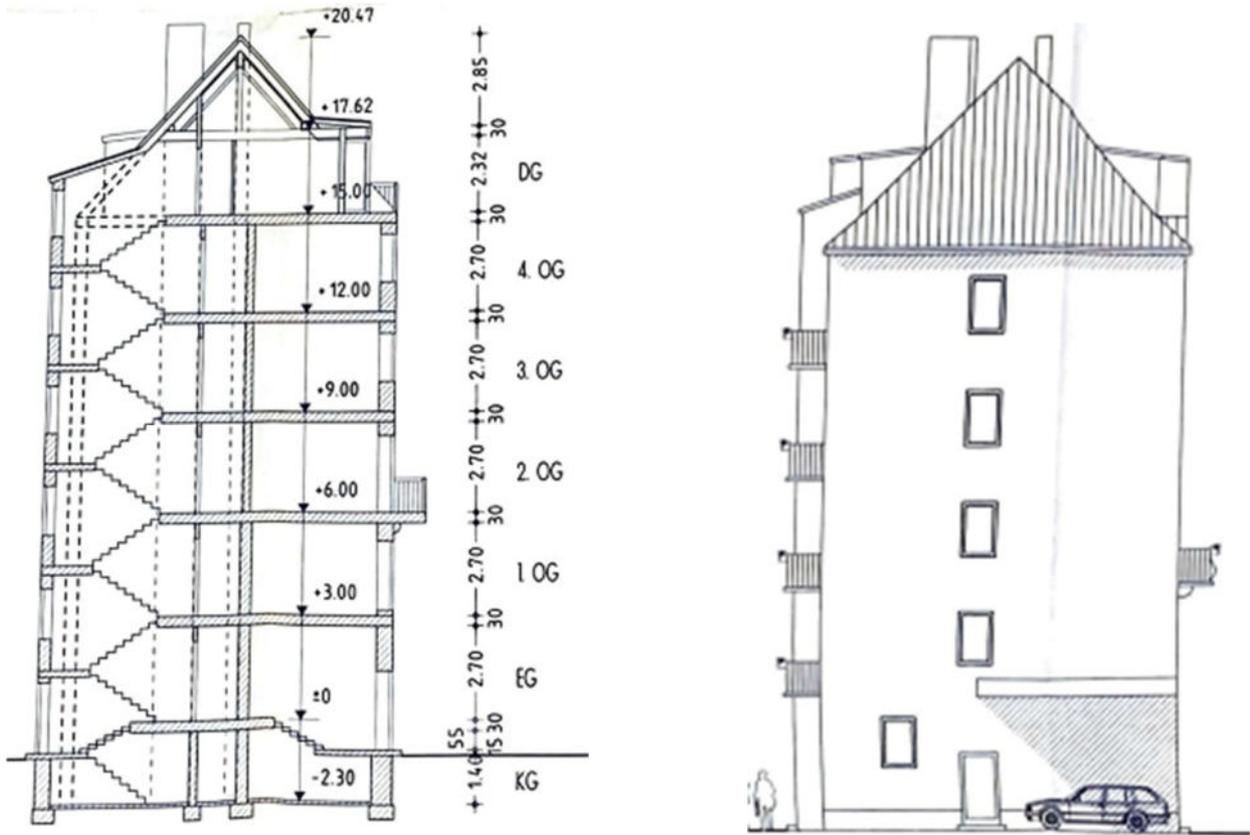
Gebäudeschnitt und Ansicht aus dem Baujahr 1999
